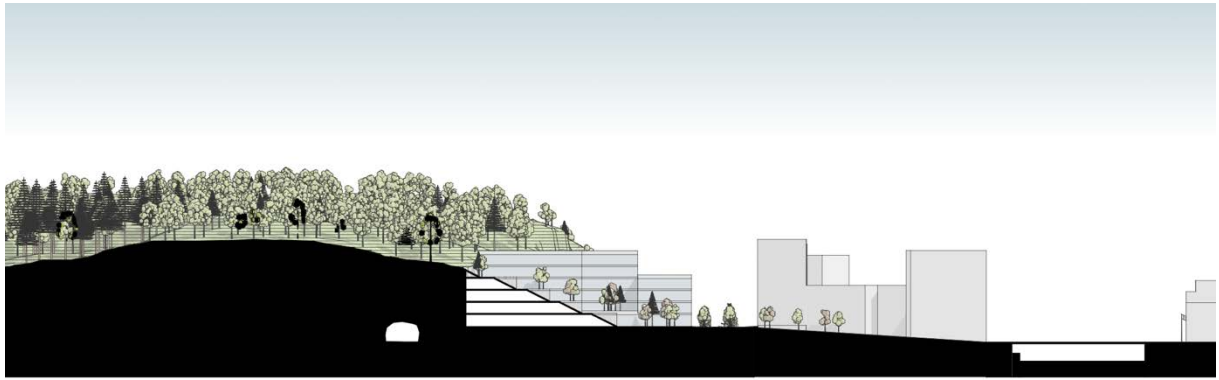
Volumstudie for planområdet sett fra øst med Dokka sør-planen til høyre
